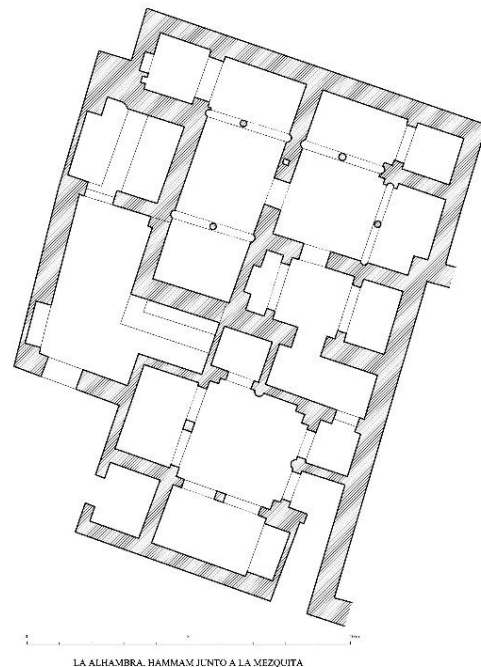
PLANTA DOS BANHOS DA MESQUITA-
